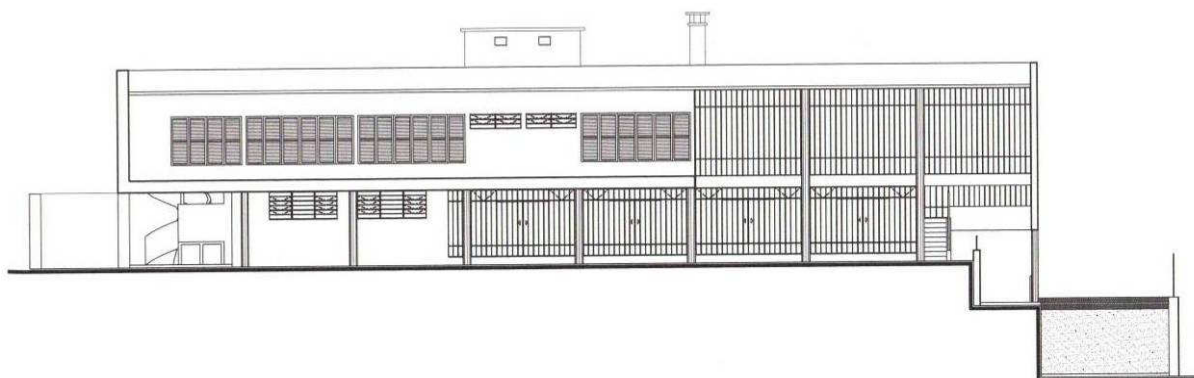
ELEVAÇÃO LATERAL ESQUERDA, FACHADA NNO
